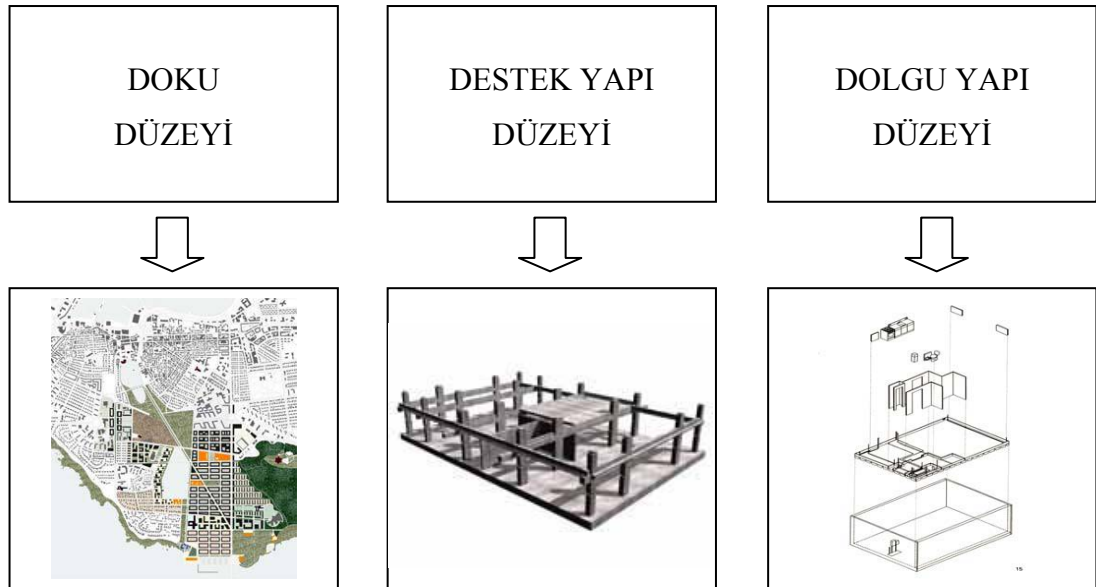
Açık Yapı yaklaşımında yapay çevre düzeyleri (Open Building, b.t_d)
